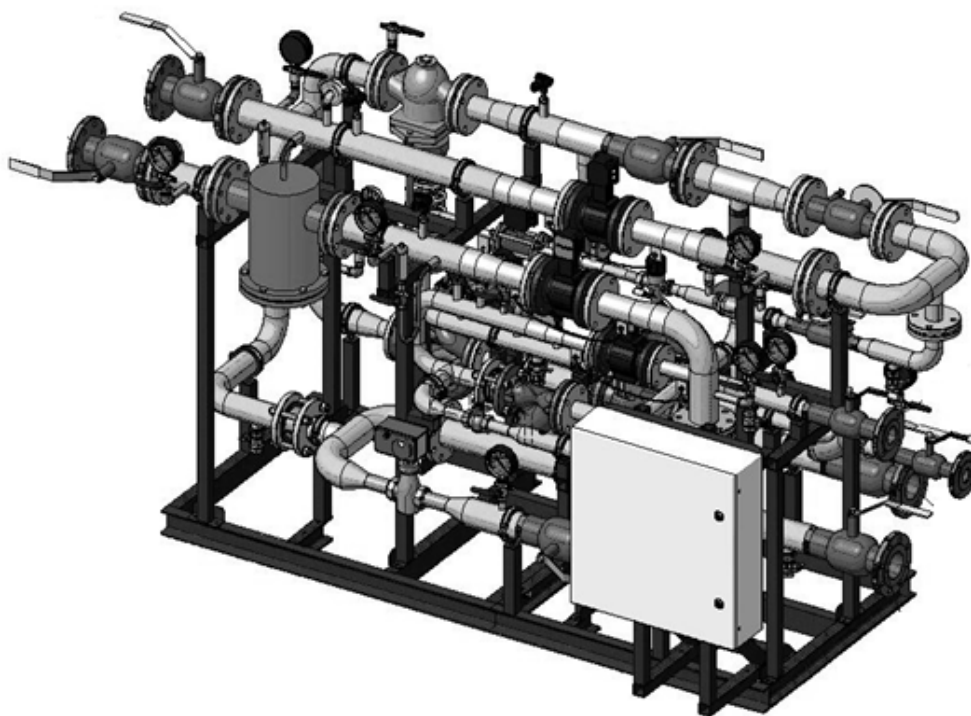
Блочный индивидуальный тепловой пункт, собранный на единой раме
